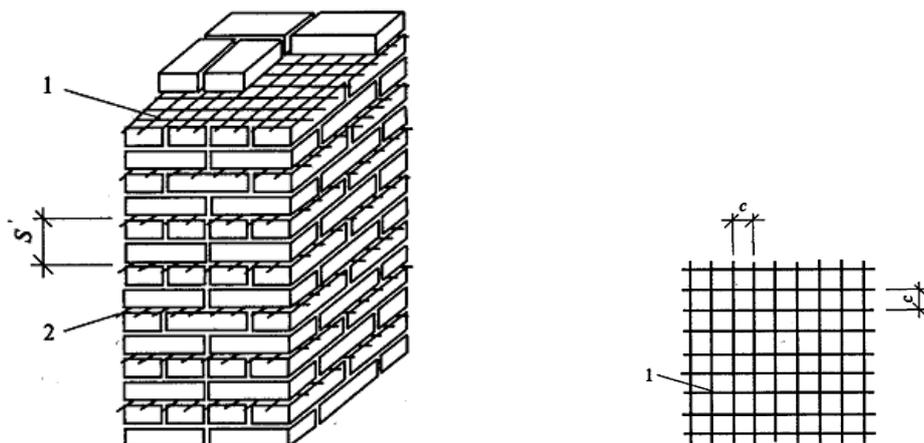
Поперечное (сетчатое) армирование каменных конструкций
